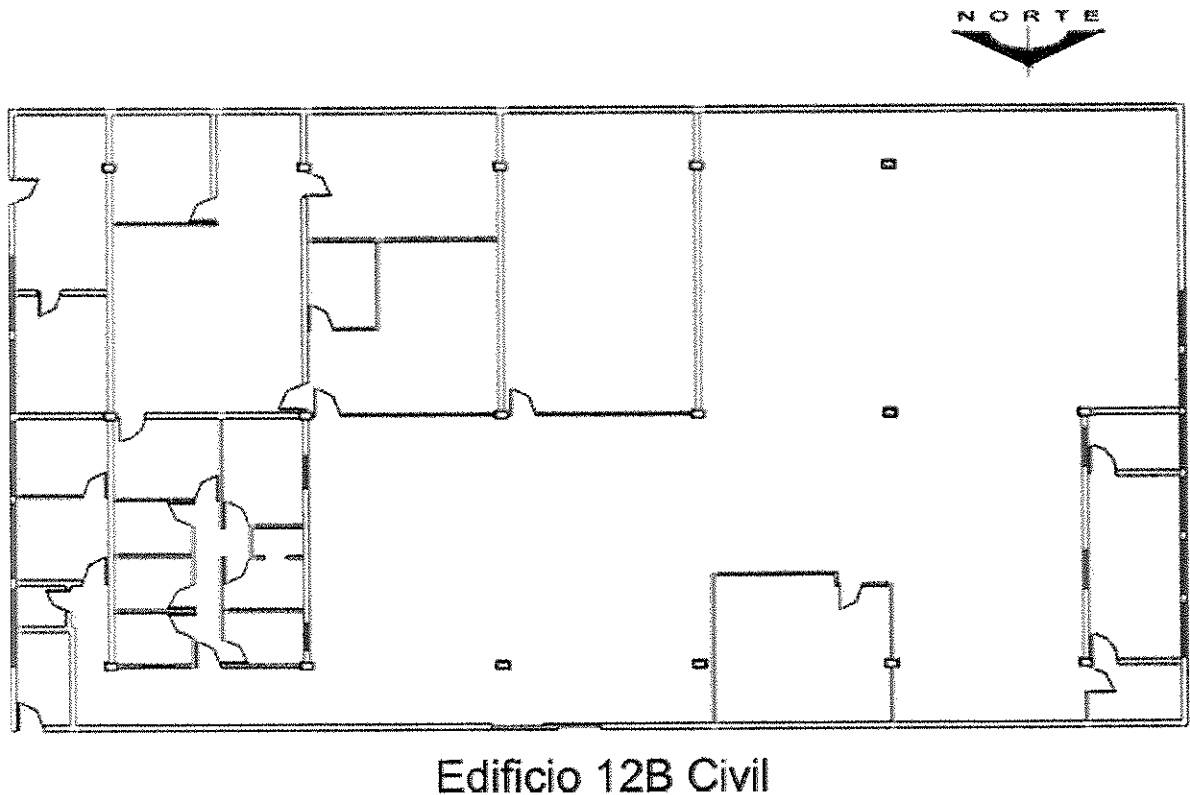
Plano de un edificio donde se pueden observar los equipos del equipo activo.
